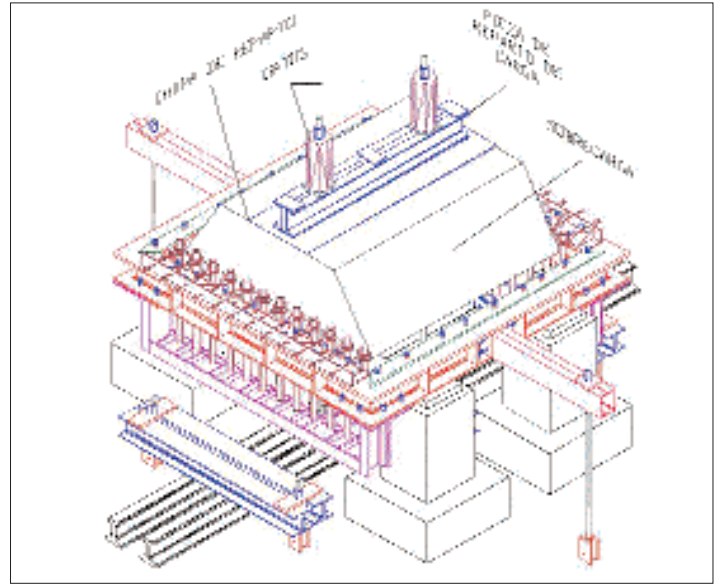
Vista general del aparato de ensayo para el ensayo de carga distribuida Unidireccional, con la sobrecarga.
